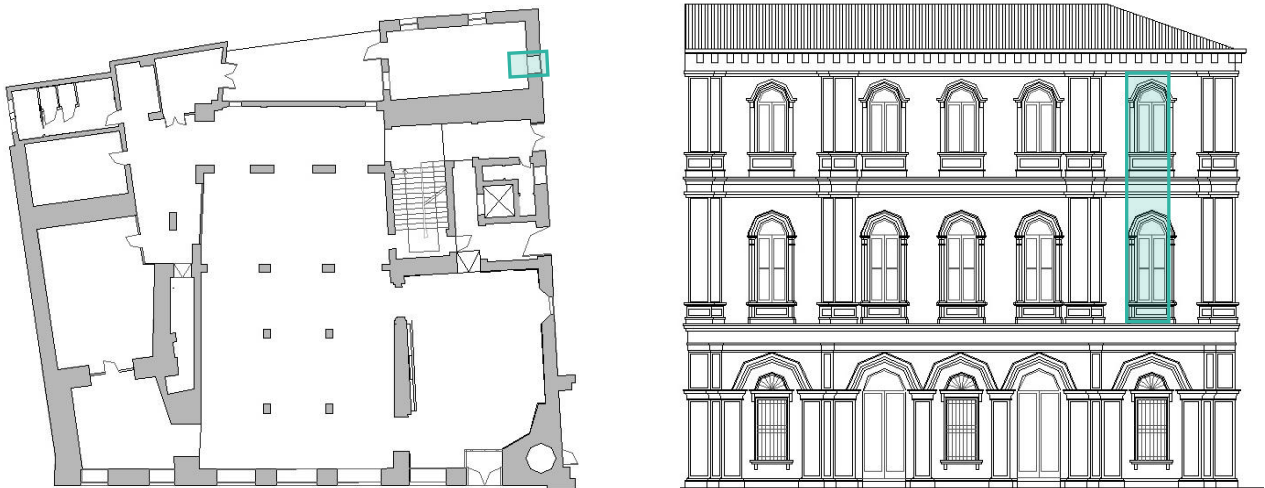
Individuazione macroelemento, pianta e prospetto
